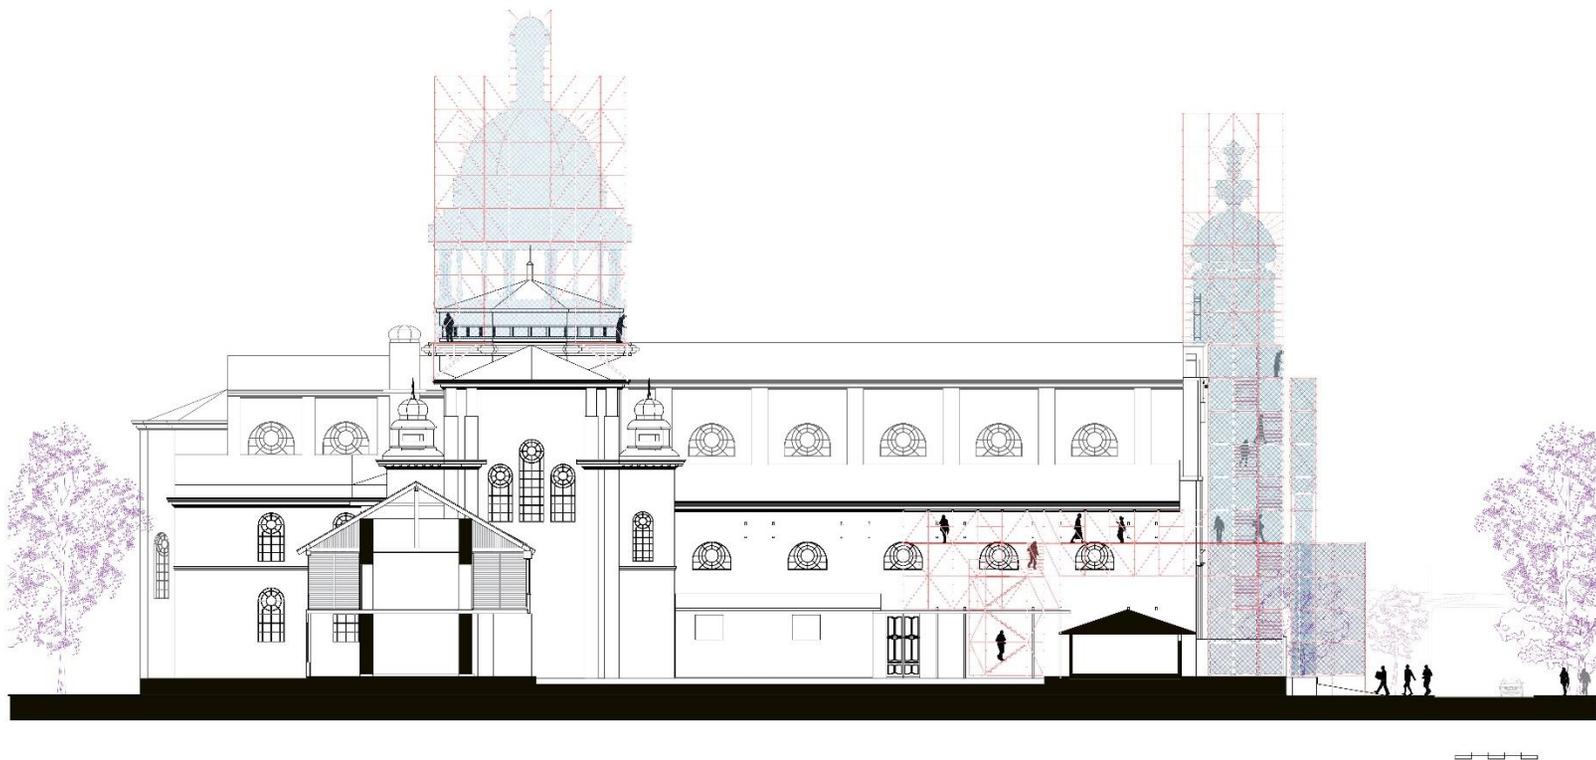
Planimetría proyecto. Elevación lateral. Las pasarelas planteadas en el exterior tienen su origen en las actuales salientes metálicas que allí se encuentran, por lo tanto, se ubican a esta altura para poder visitarlas. Elaboración propia
